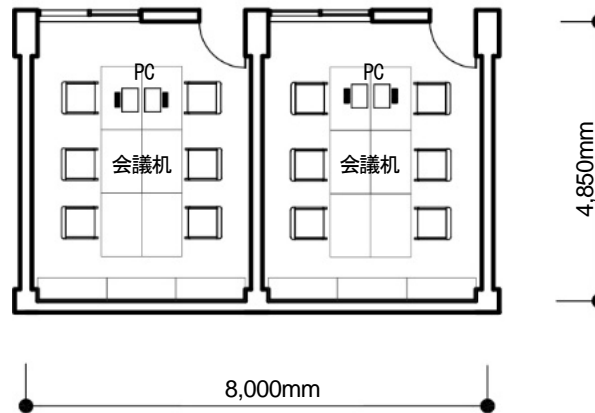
連盟事務局室／柔道連盟事務局室平面図
